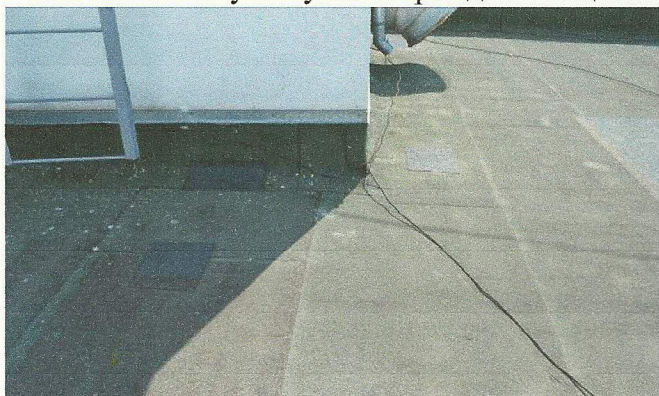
Участки ремонта покрытия кровли путем наклейки заплат
